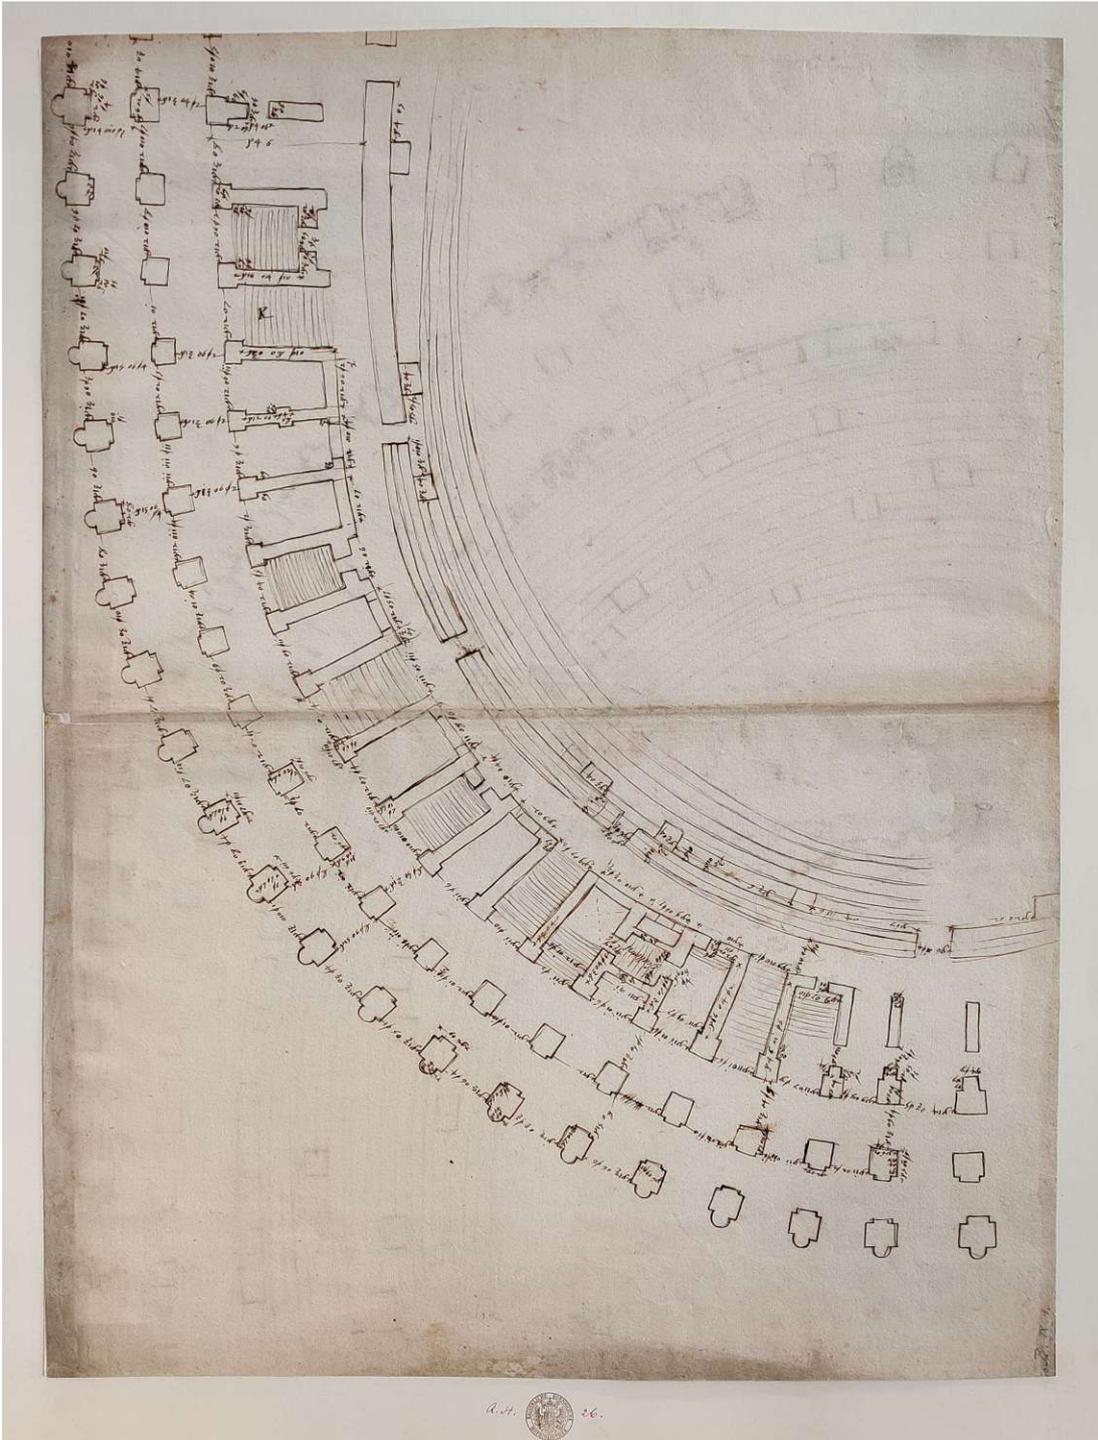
Recto: Kolosseum: Teilgrundriss des nordwestlichen Quadranten | 1. Obergeschoss
